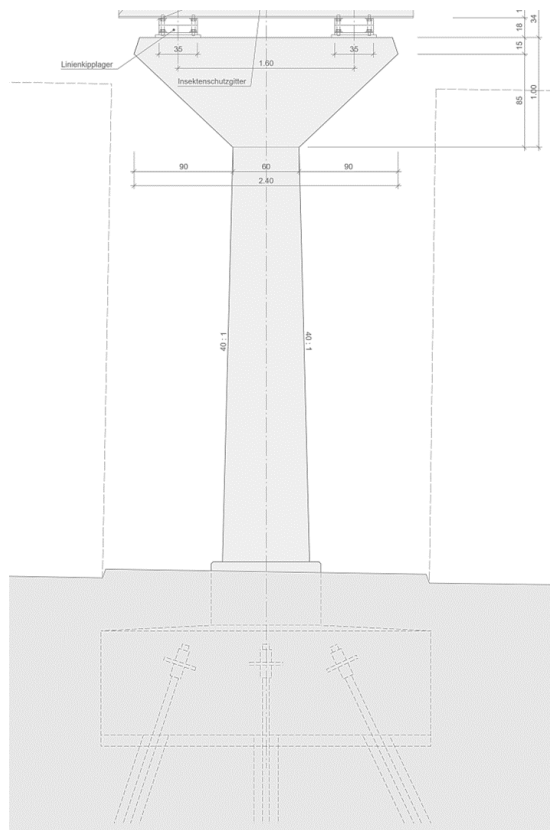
Stützenquerschnitt mit Fundation im Bereich des Strassenknotens
